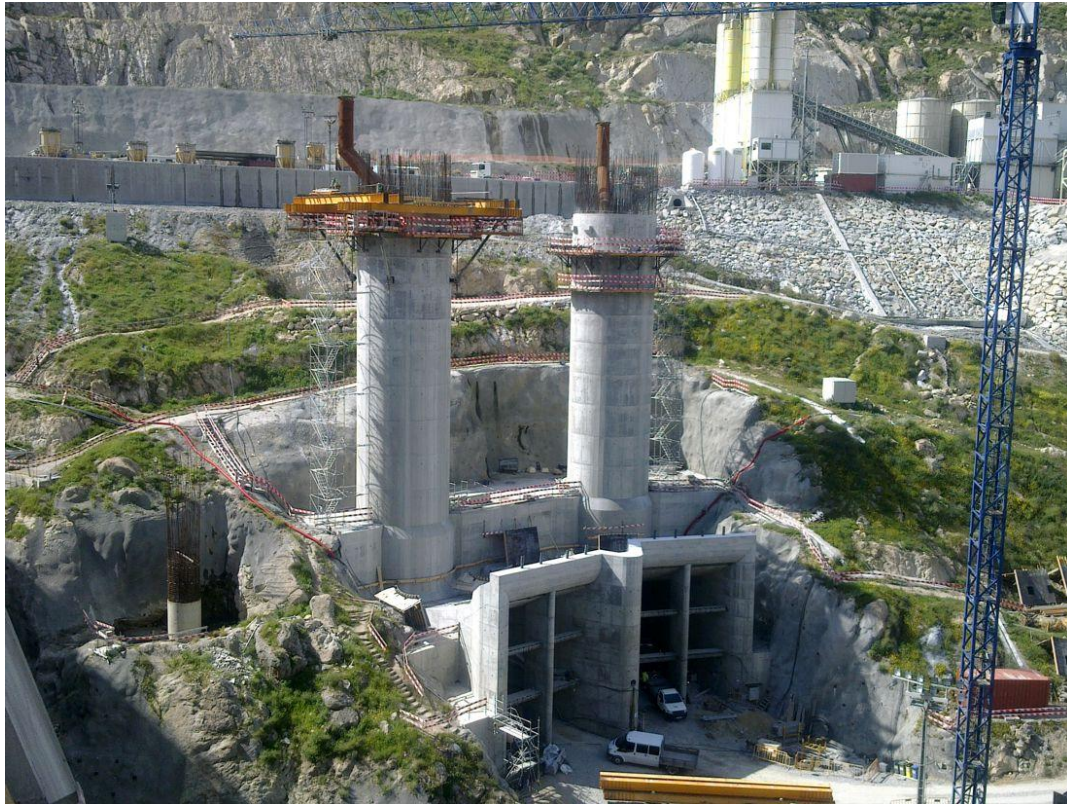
Construção dos poços da barragem do Baixo Sabor, retirado de (FCM, Consult. 12/06/2025).
